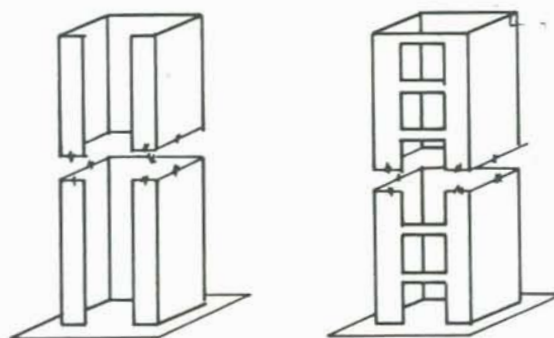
Paredes com e sem vigas de contraventamento
